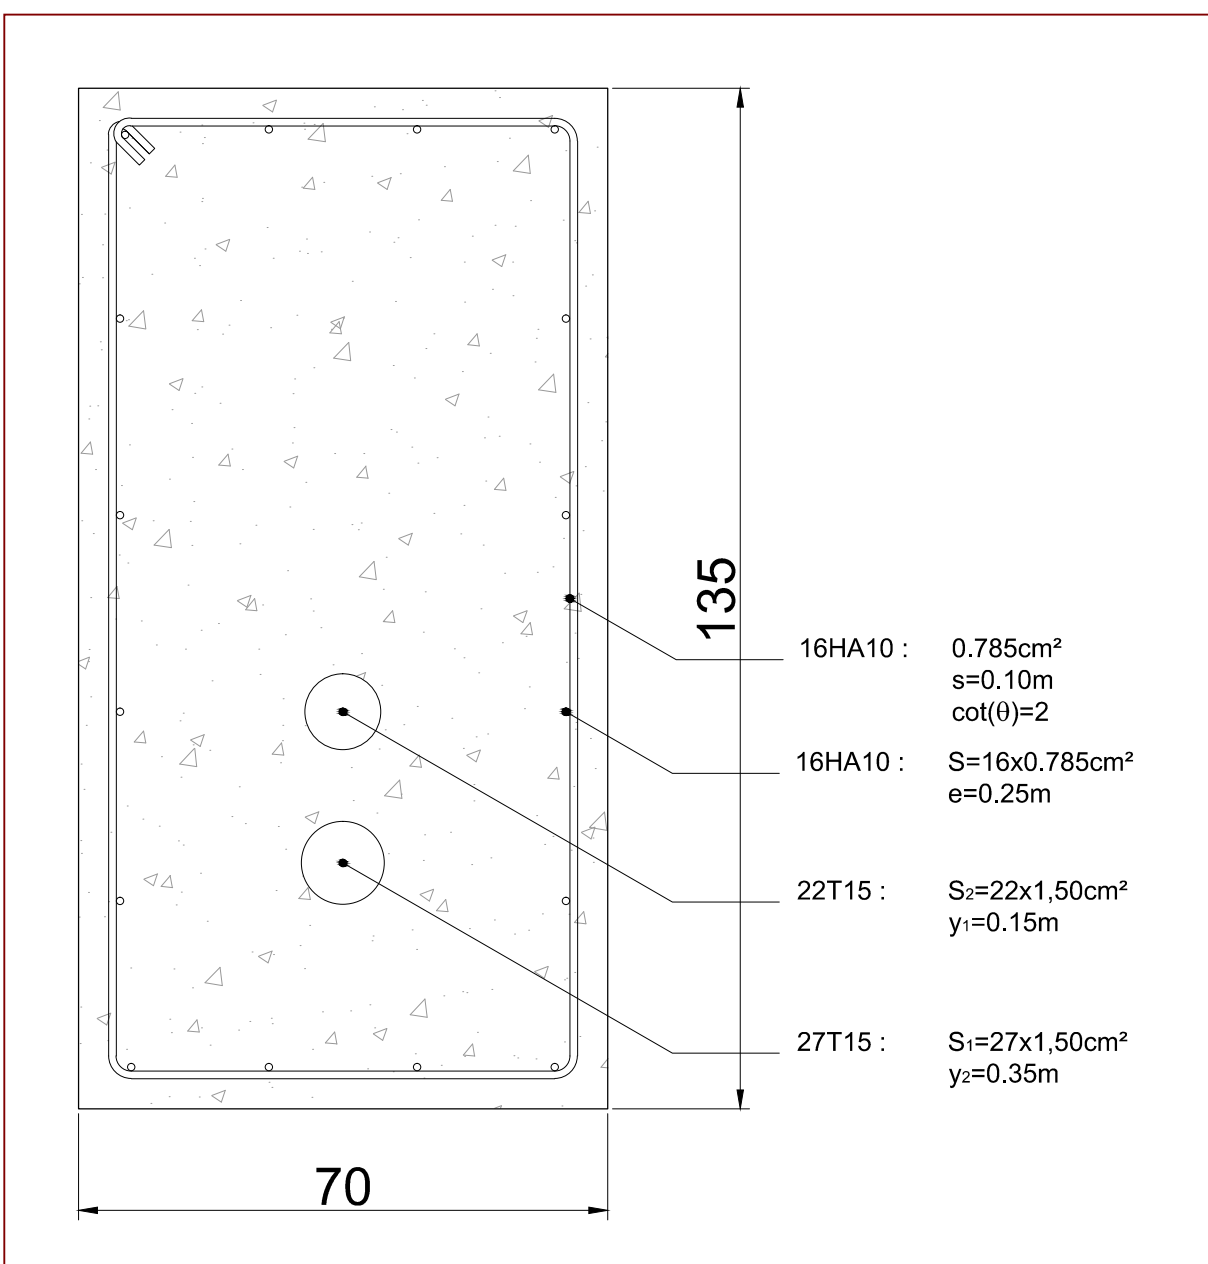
Posizione dei ferri nella trave di calcestruzzo armato precompresso
